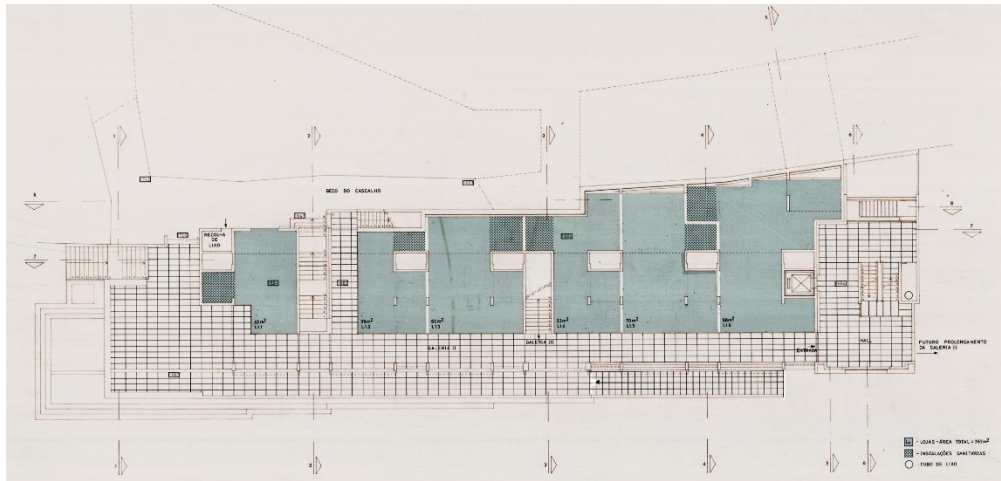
Planta do Piso 1, Projeto Geral – 1ª Fase, Rua do Marquês de Alegrete - EPUL, fevereiro de 1974.
